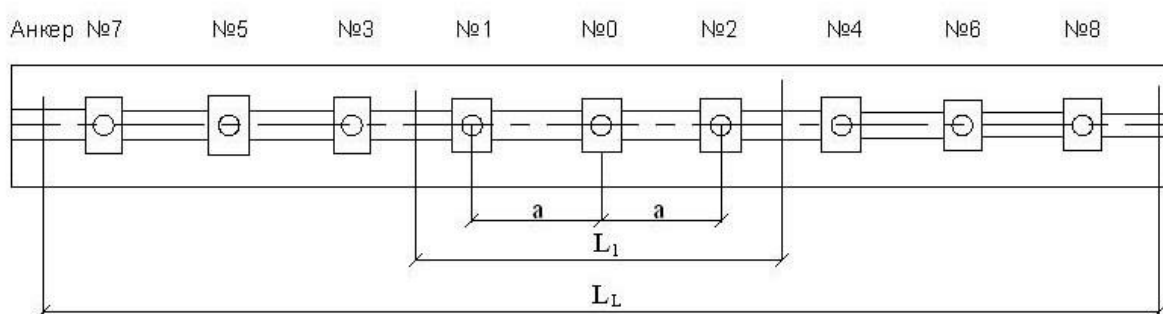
Схема расположения анкеров на продольном поясе (анкер № 0 – отказ при испытании)
